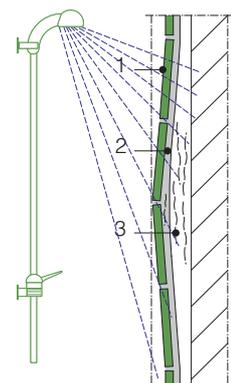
Bombement et fissuration du carrelage occasionnés par l'ettringite secondaire.
